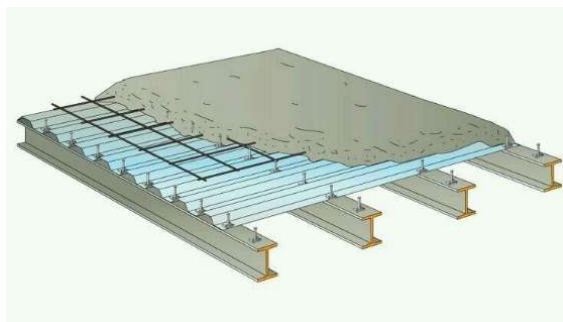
Schéma d'une dalle mixte composée d'un bac acier collaborant, d'un treillis soudé et de béton coulé
